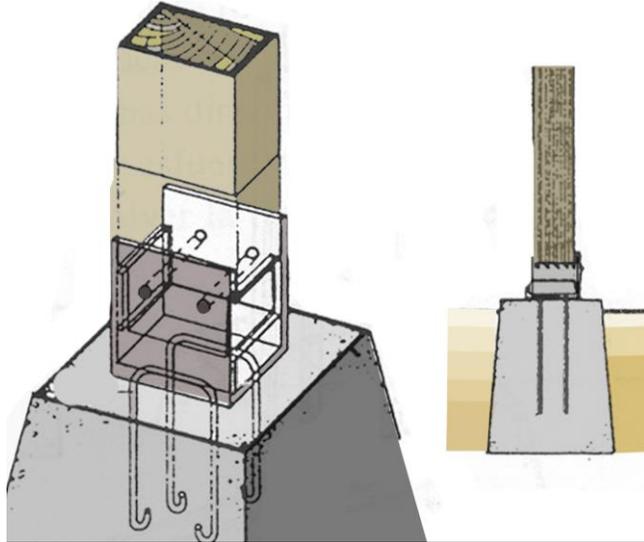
Detalle de herraje metálico. Consiste en una placa metálica en forma de “U” unida a dos aros de acero que se anclan al dado de concreto.
